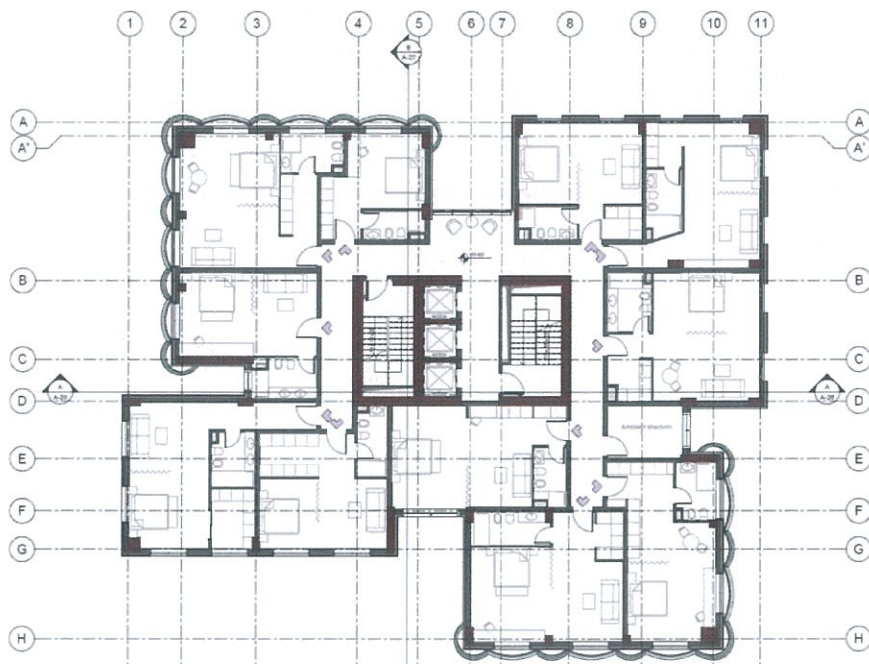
Plani i Katit +15 - Hotel, Kuota +55.62
